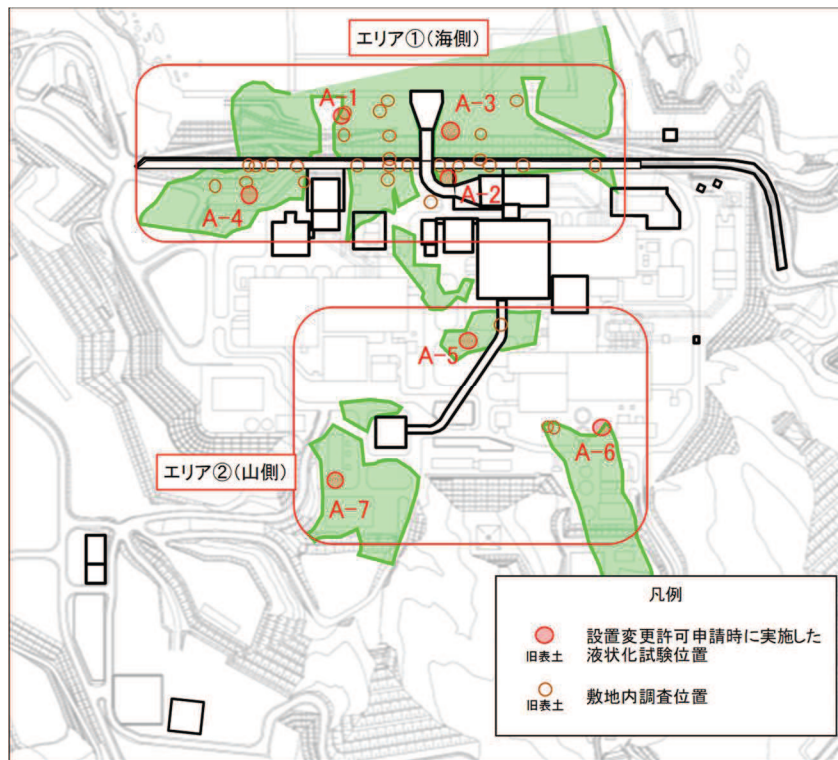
旧表土の液状化強度試験位置及び敷地内調査位置の平面図
